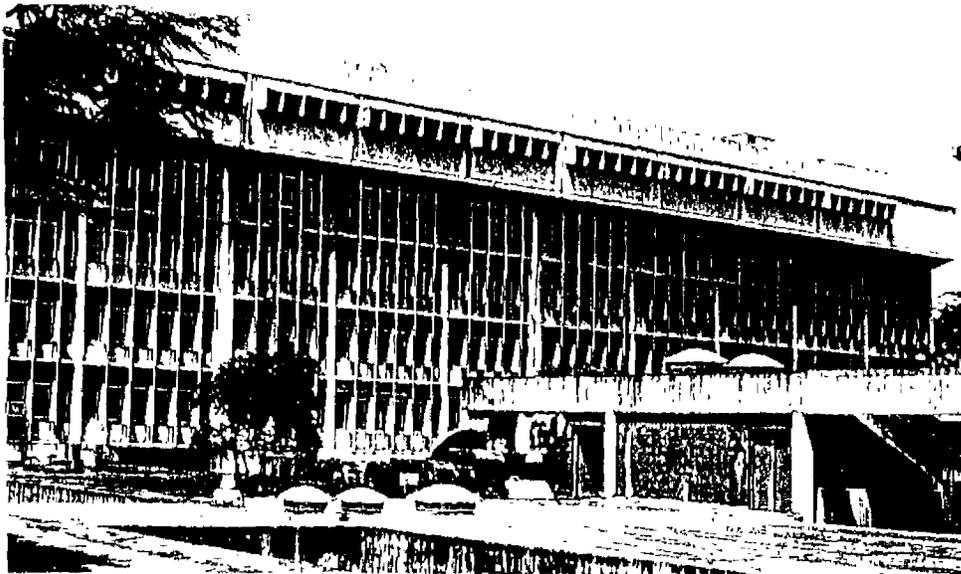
VISTA DEL CUERPO A, DESDE EL EXTREMO NOR-ESTE DEL TECHO DEL CUERPO B. PARA LA FACHADA SUR VEASE LA FOTO 1.1
